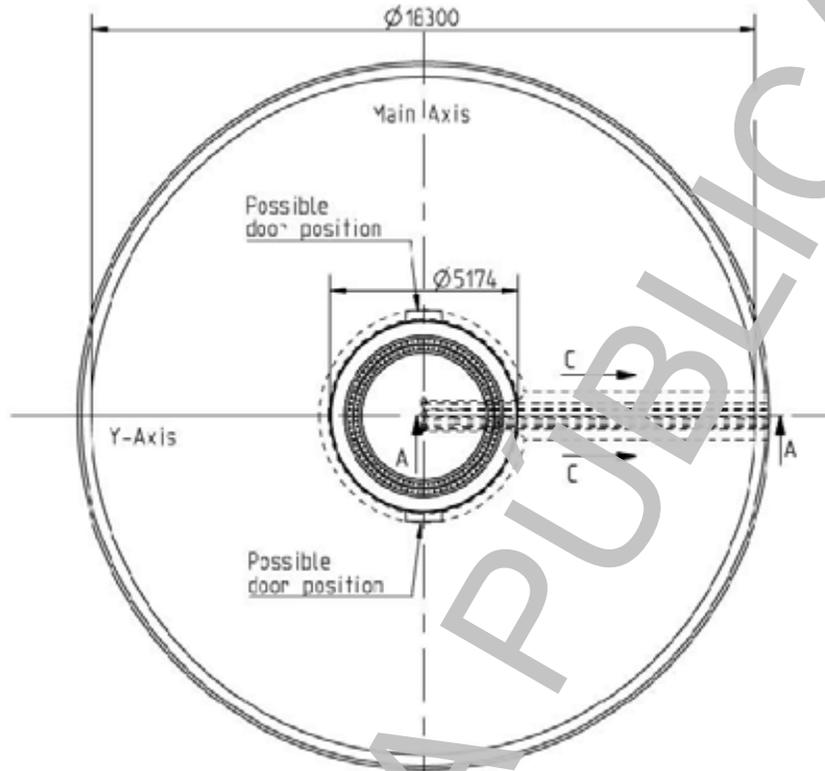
9. Esquema de cimentación, zapata y acople de torre
